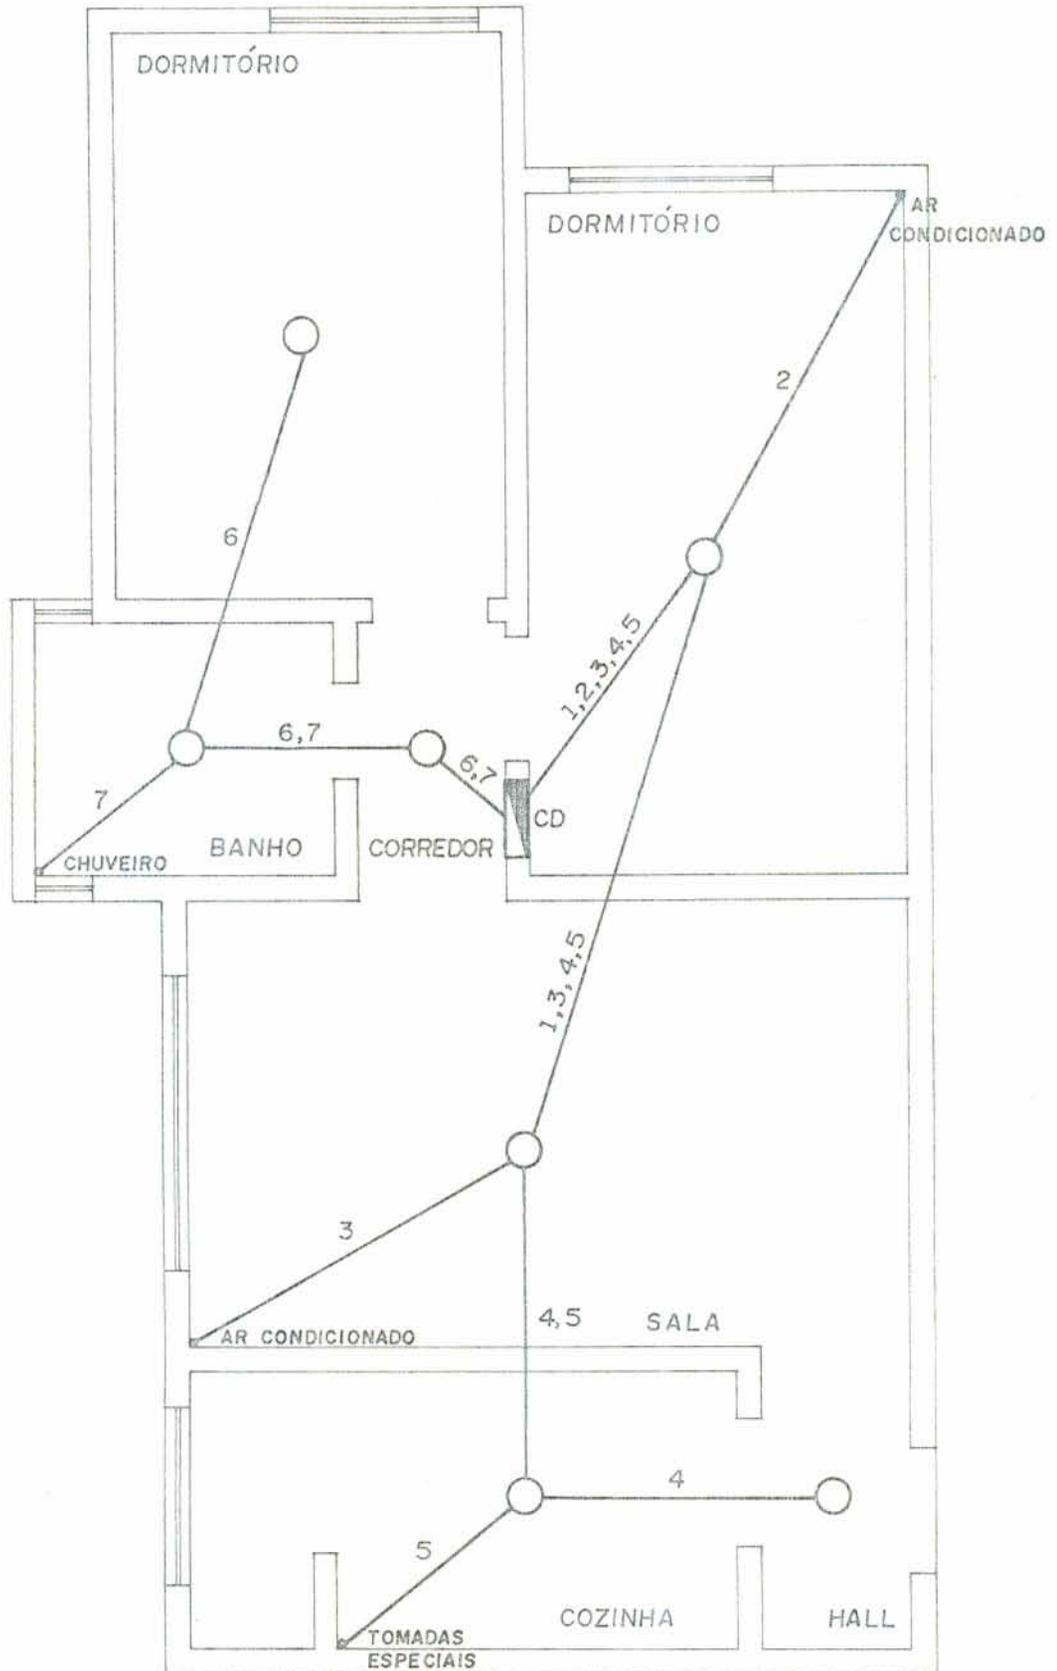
PLANTA DO APARTAMENTO DO PAVIMENTO TIPO PROJETO DE INSTALAÇÃO ELÉTRICA
